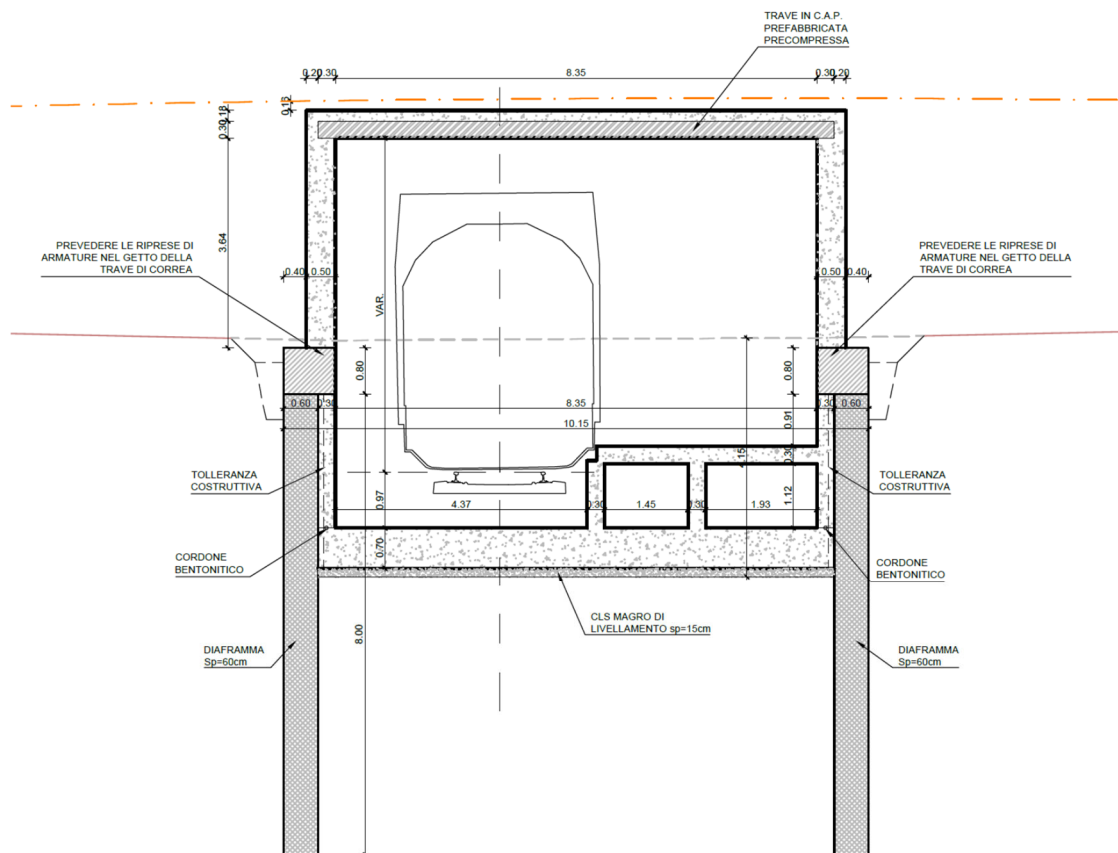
Scavo con diaframmi – sezione TIPO Ri4
